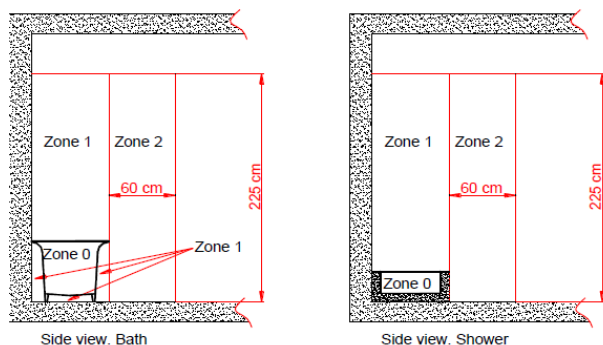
Dimensiunile zonelor din jurul băii, dușului sau cu piscină
